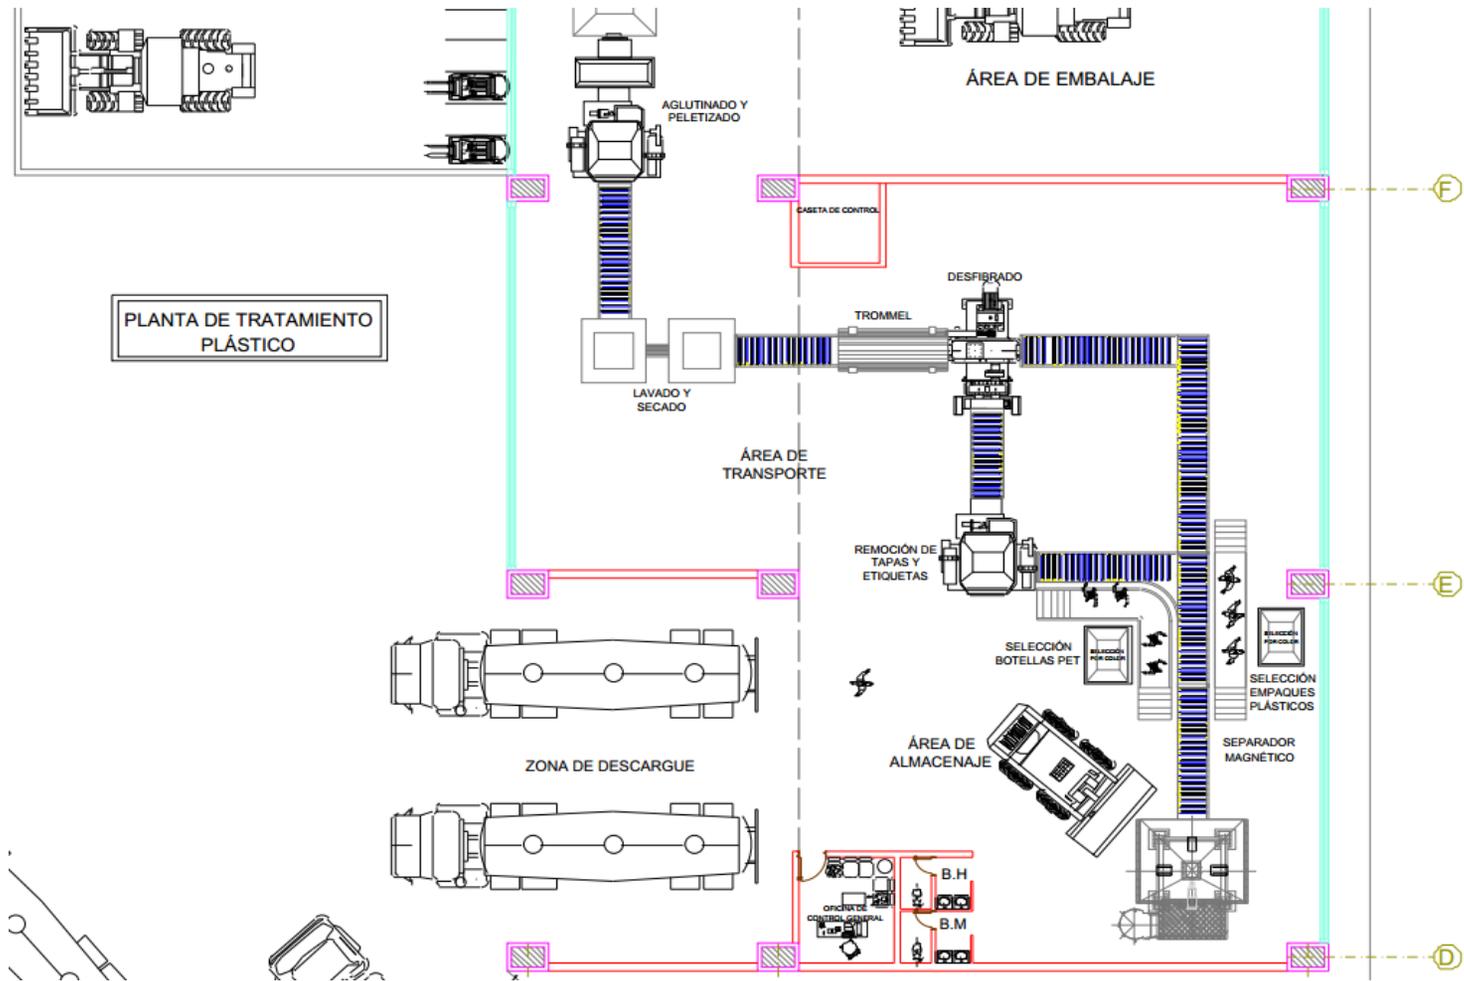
Vista de zona de procesamiento de plástico a detalle n° 1, esta muestra una sección de la zona y el proceso anteriormente mostrado.
